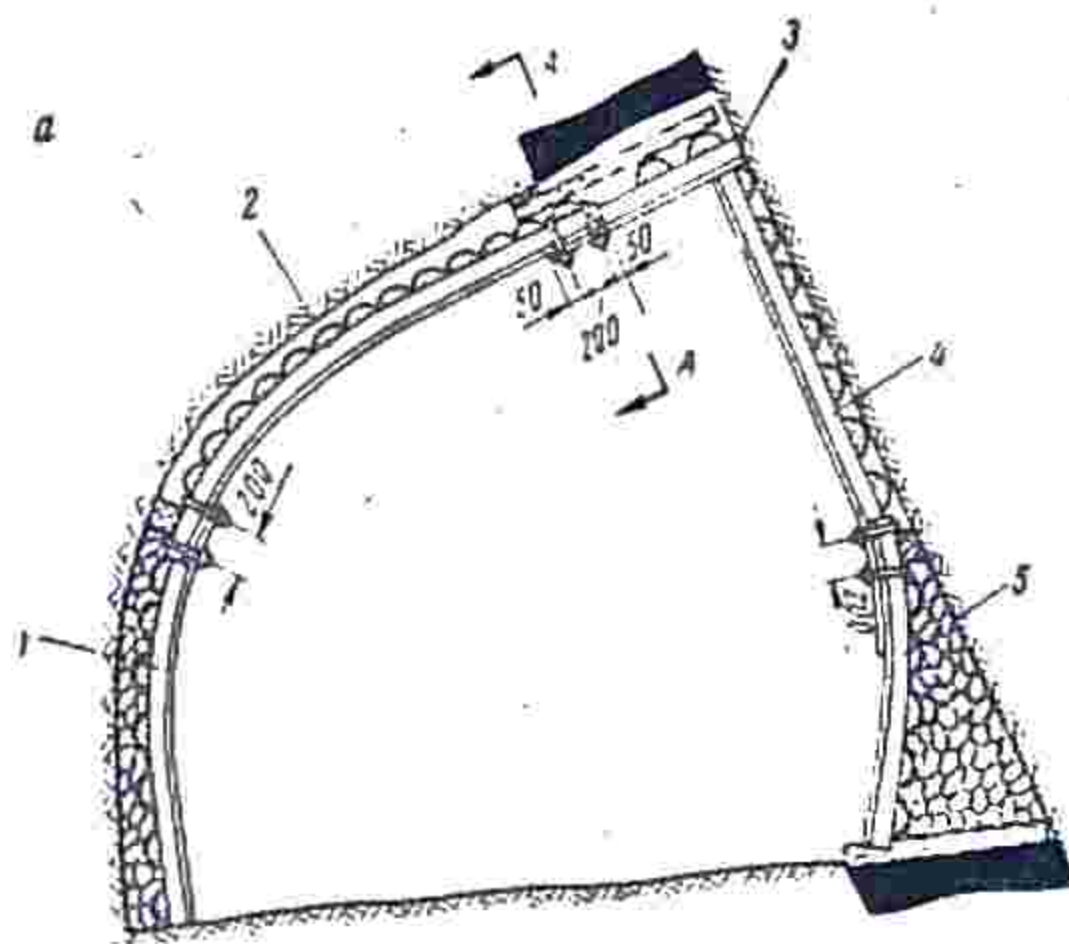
Металлическая податливая крепь для выработок на пластах крутого падения
